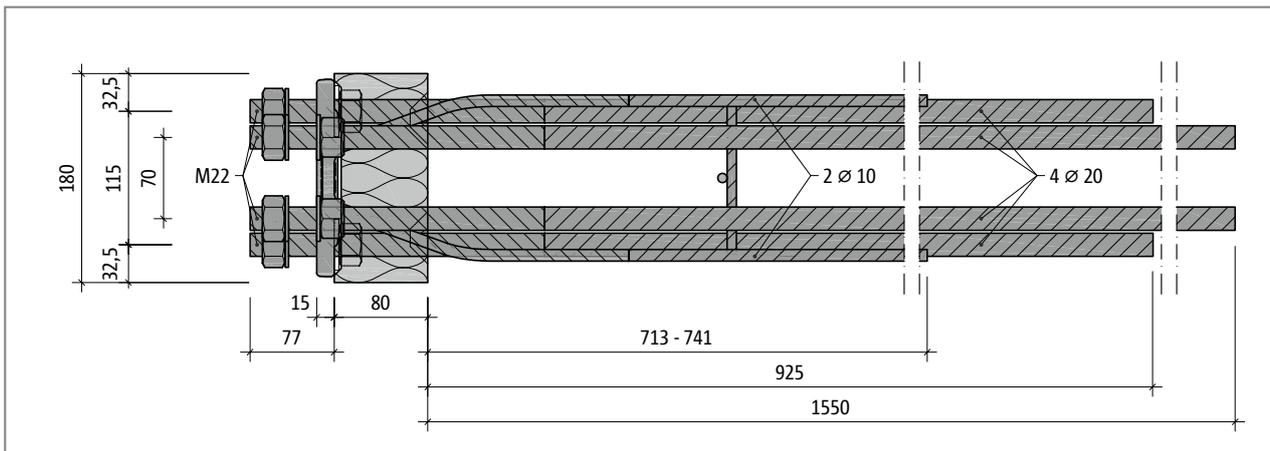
Schöck Isokorb® T type SK-MM2-VV1 : plan de base
